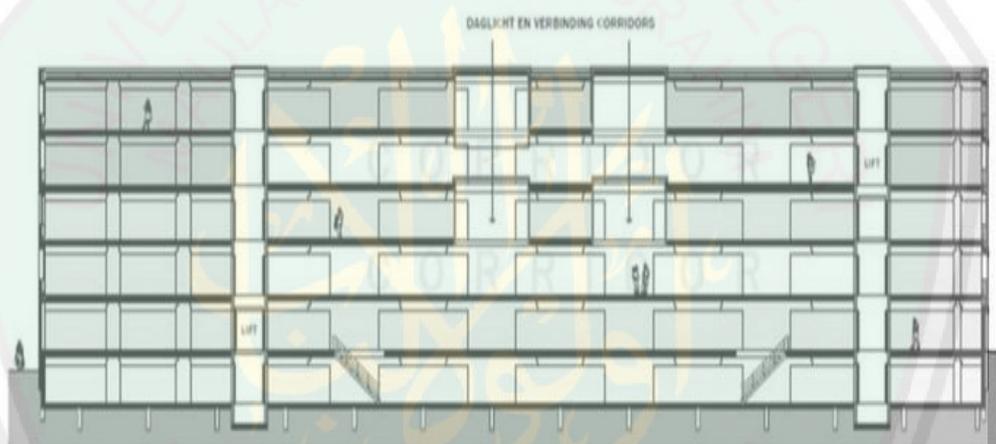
blok-blok bangunan multifunk (sumber:www.lingotto.nl)
